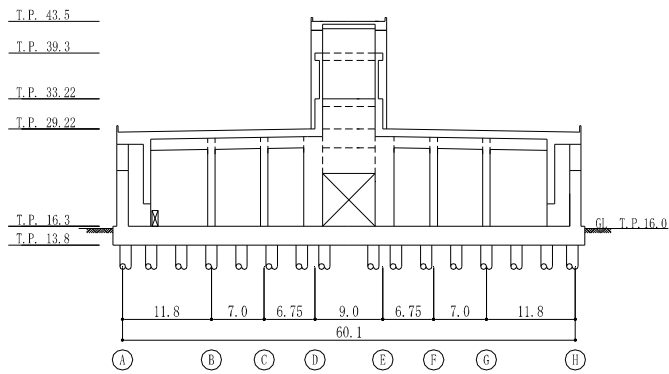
B-B 断面図 (EW 方向) (単位：m)
